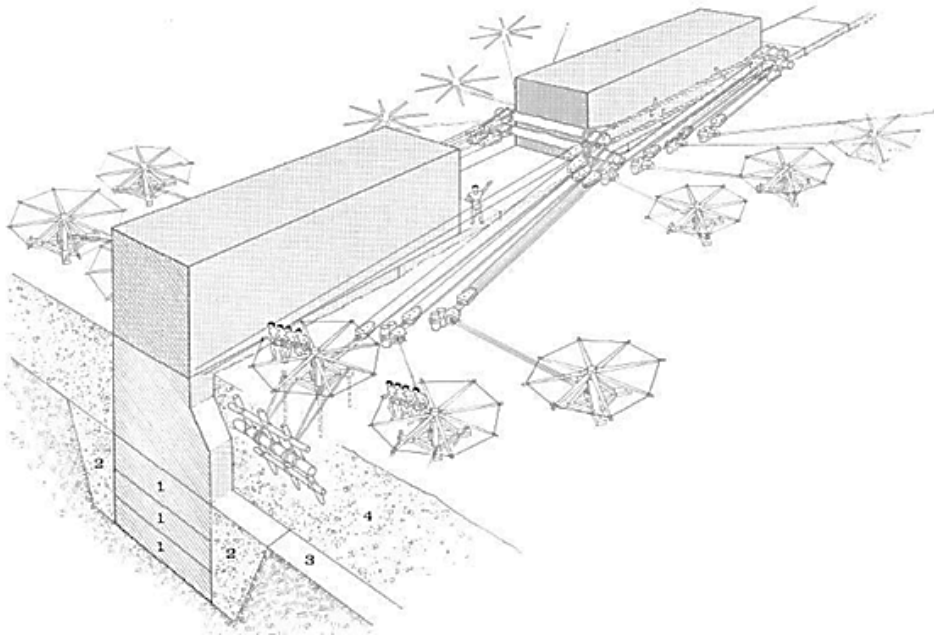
Гіпотетичне пересування мегалітичних блоків за А. Jean-Pierre: 1Блок основи, 2 котлован фундаменту, 3 рівень землі, 4 відсіпка ґрунту [18].
